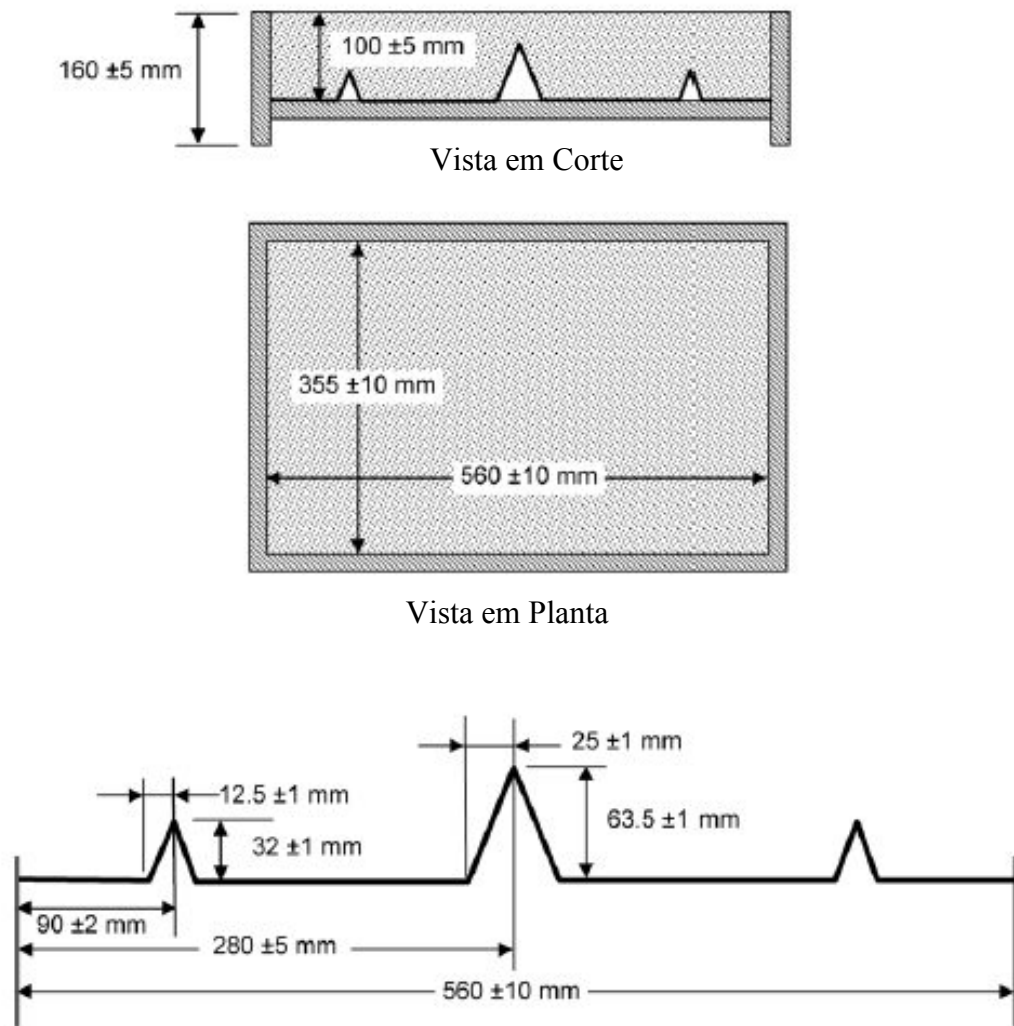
Moldes utilizados para o ensaio de fissuração.
